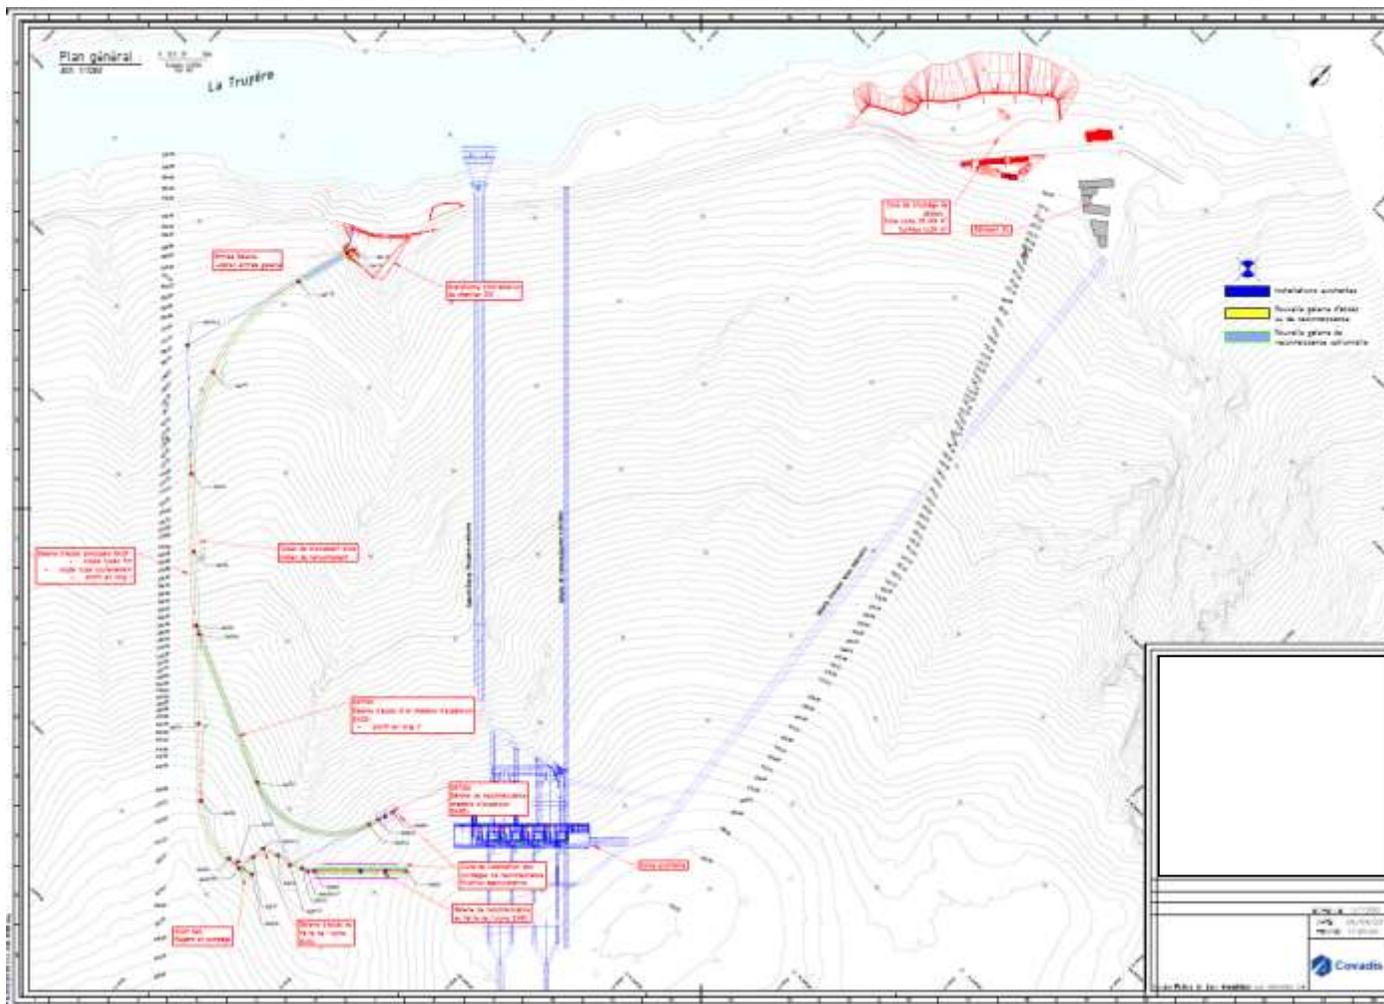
plan de principe de localisation de la galerie de reconnaissances, des zones de travaux extérieurs et de l'aménagement existant – vue en plan - source : EDF
